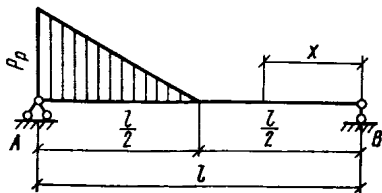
Расчетная схема при втором варианте снеговой нагрузки
